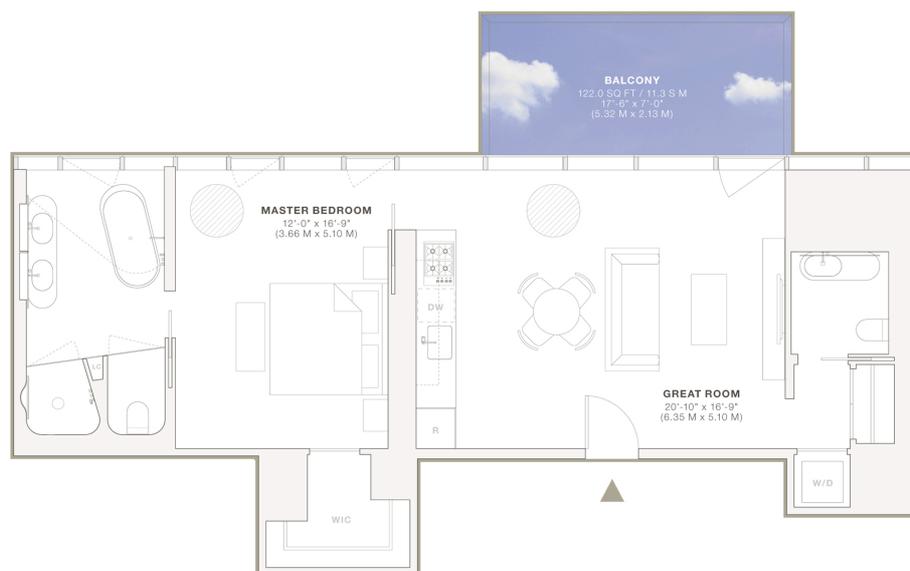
Planta apartamento com 1 quarto 60 m2 área privativa
